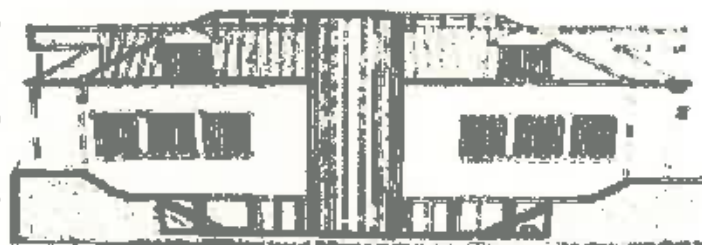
Fachada Posterior, realce para a saliência do novo elemento, as escadas.
